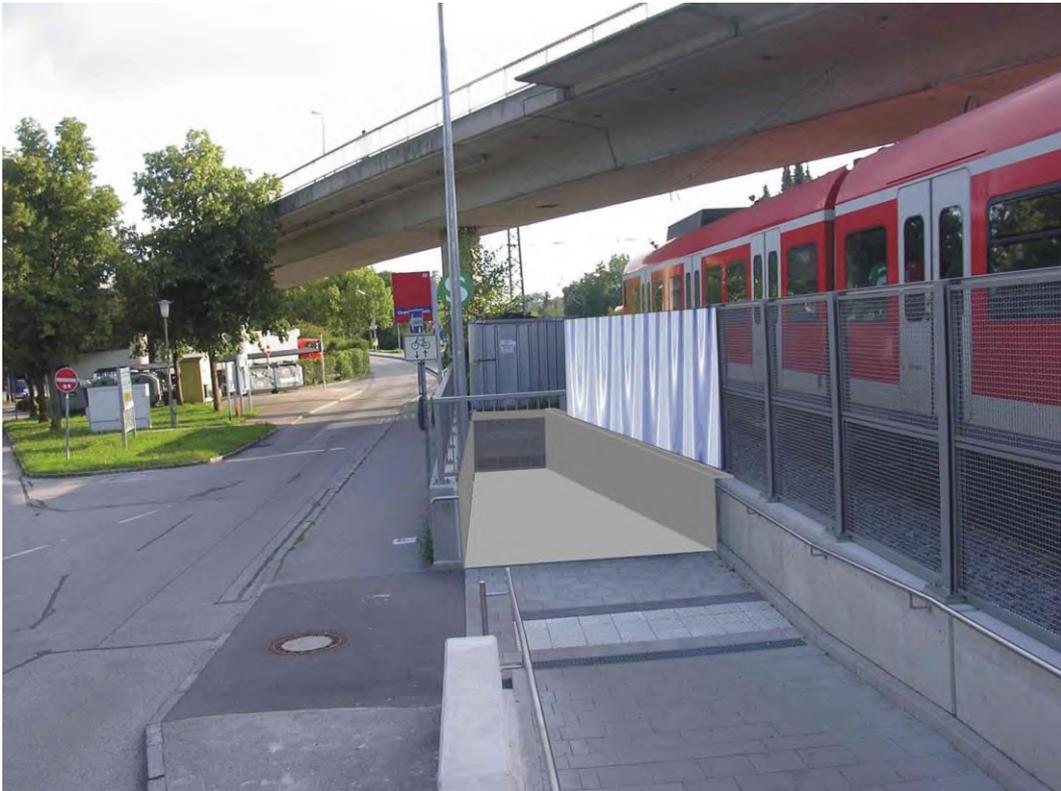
Bau einer Rampe in Verlängerung der bestehenden Rampe - Ideenskizze
